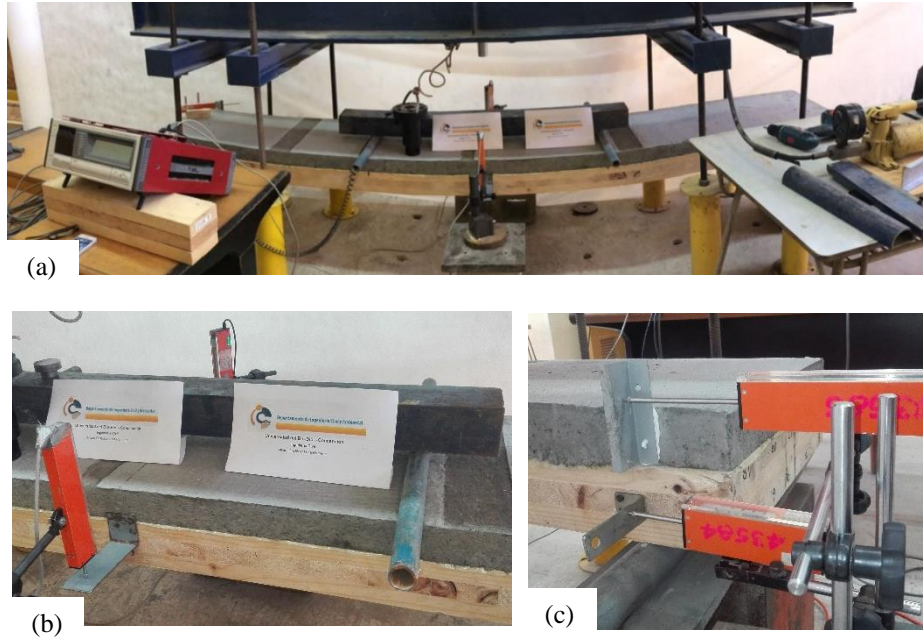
Disposición y ejecución de ensayo losa híbrida.
